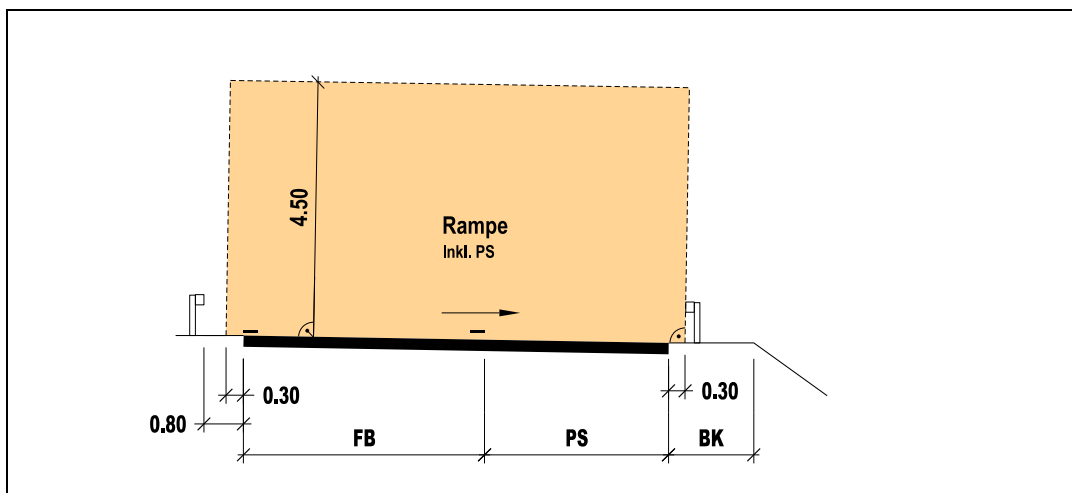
Lichtraumprofil einer Rampenfahrbahn inkl. Pannestreifen
